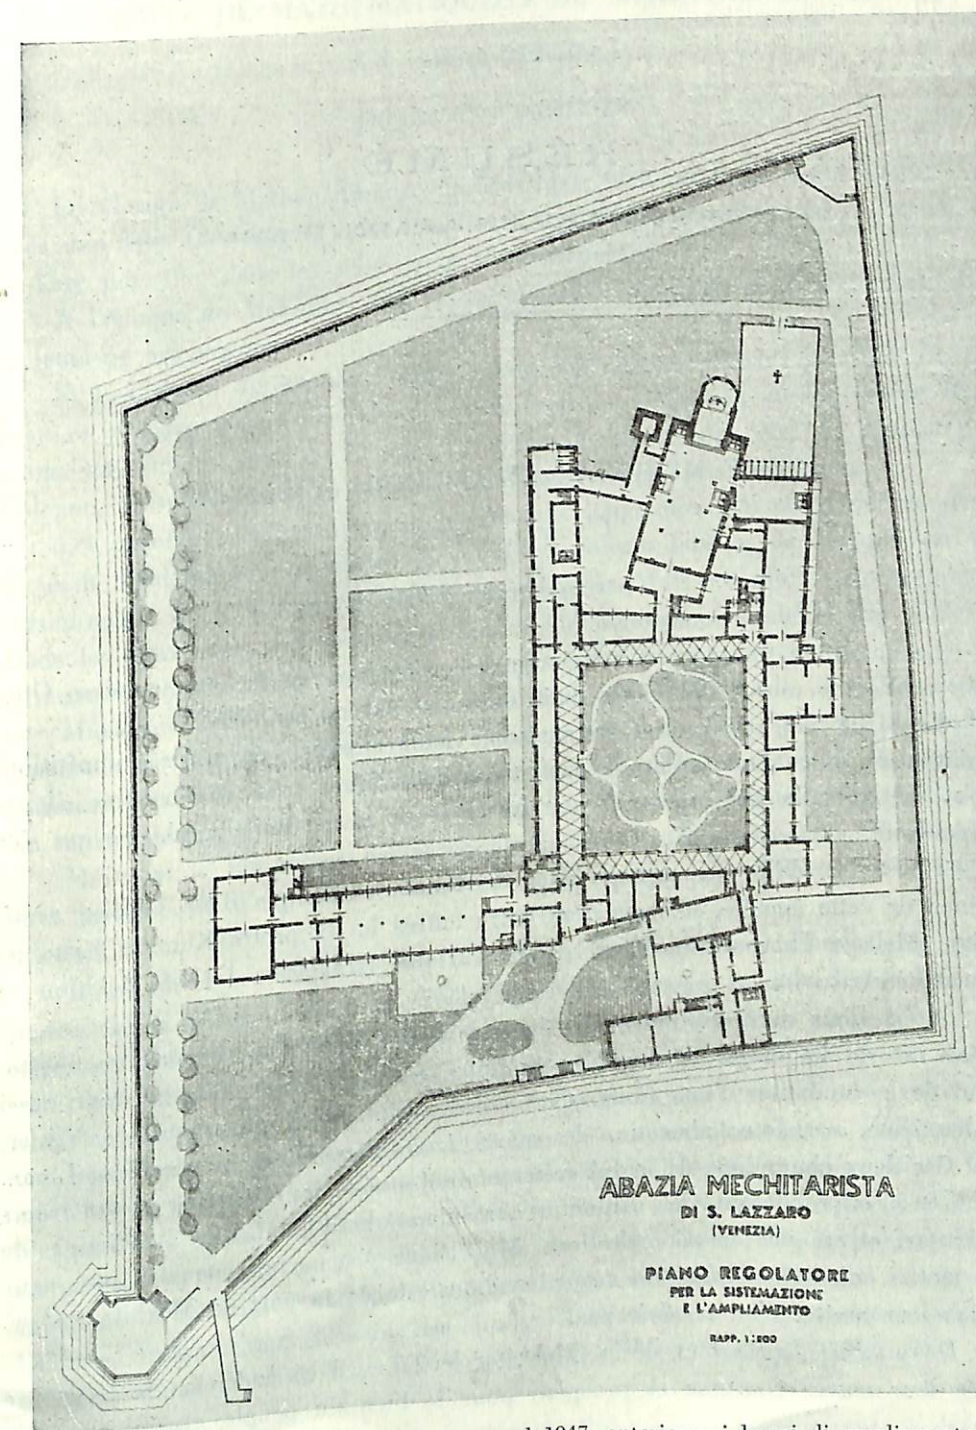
Pianta dell'Isola di S. Lazzaro nel 1947, anteriore ai lavori di ampliamento dell'Isola nel lato Sud-Est. — Ing. archit. M. Gai.
